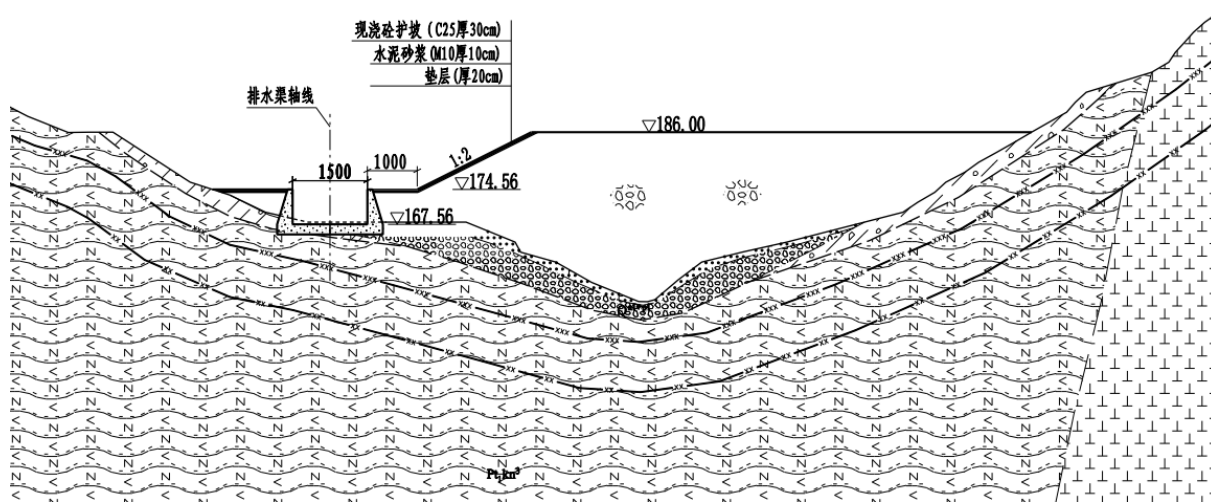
龙潭溪排导渠及永久场地典型断面图
